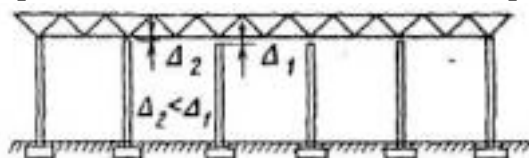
Выравнивание усилий в поясных сетках путем осадки опор
